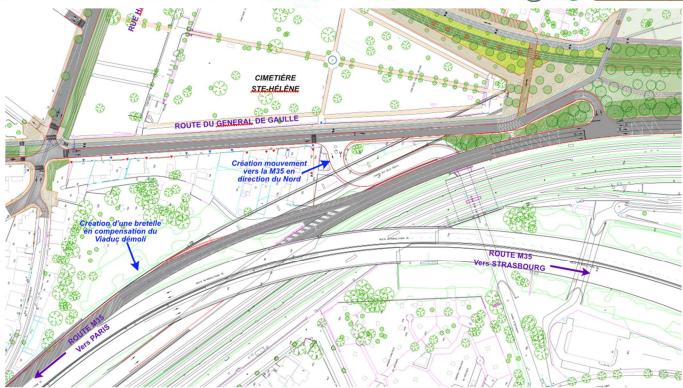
VUE EN PLAN DES CONNEXIONS PLACE DE HAGUENAU VERS M35 NORD
